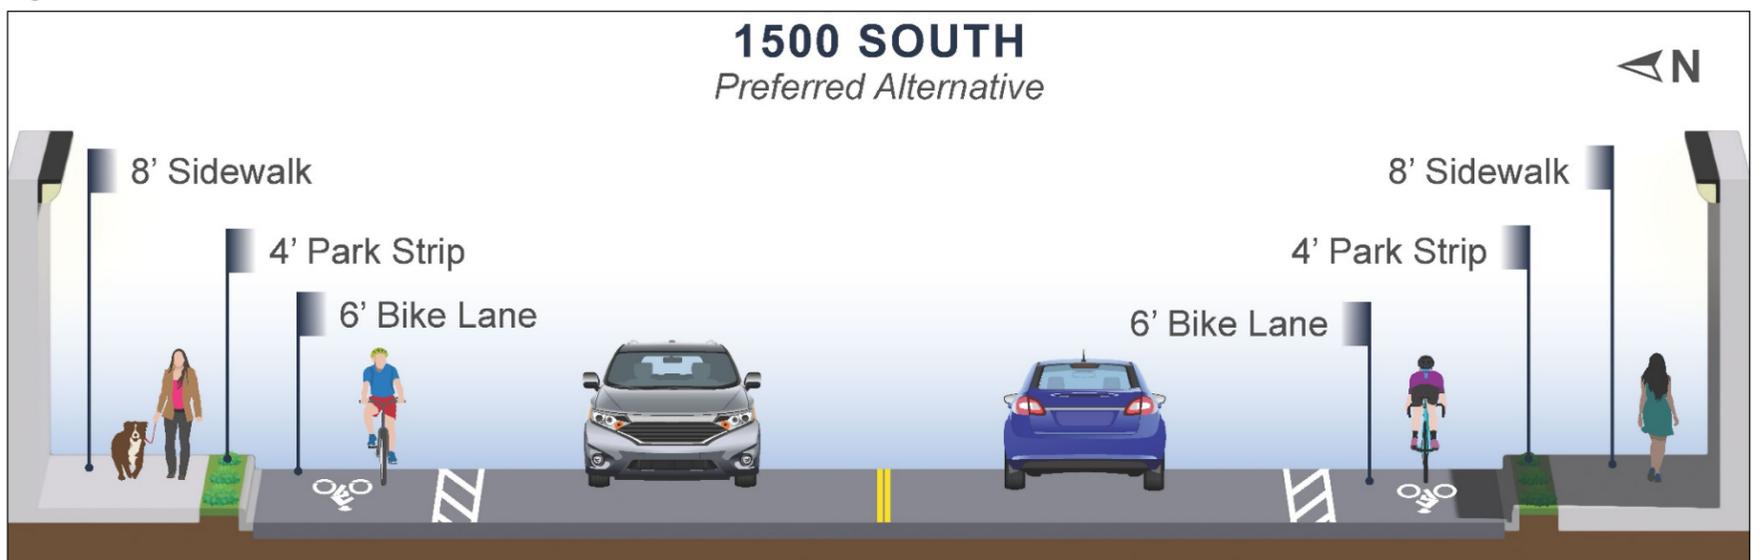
Alternativa de Acción: tramo de Salt Lake
